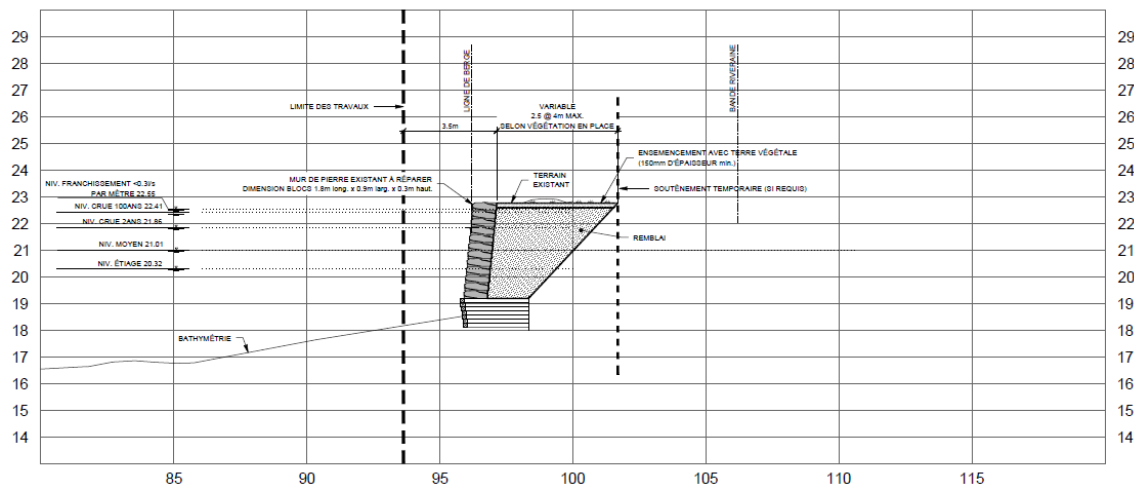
Section type de la solution retenue pour le tronçon 12 (jetée centrale) : restauration et reconstruction des murs verticaux en pierre de taille restaurés (CIMA+ Lemay, 2024)
